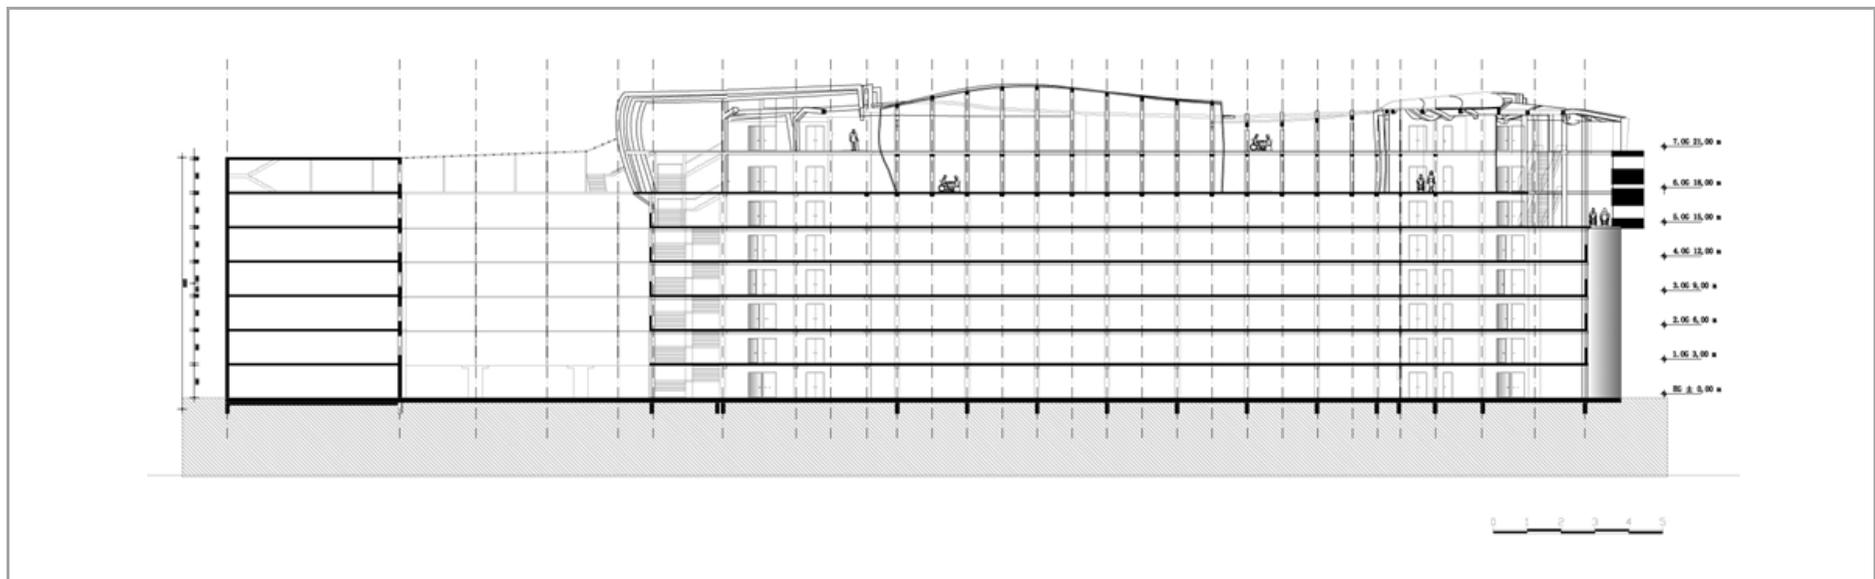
Dachaufbau Syarova – Schnitt (Key Station der TU Wien, 2008)
